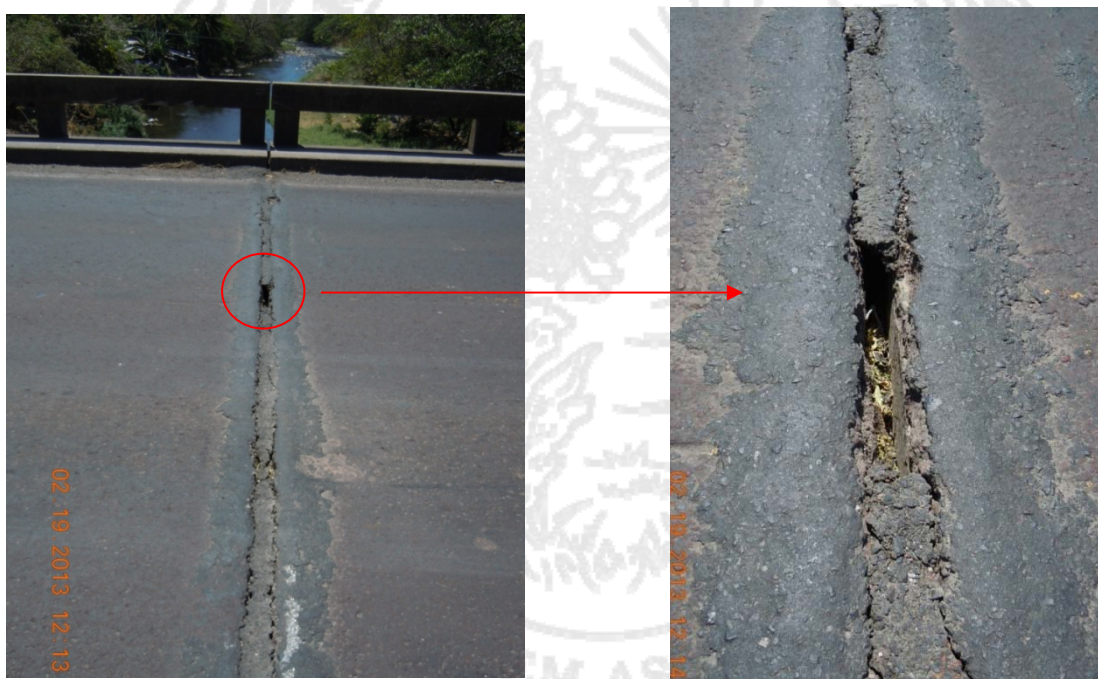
Perdida del sello de juntas de expansión selladas sobre la pila 1 entre las
